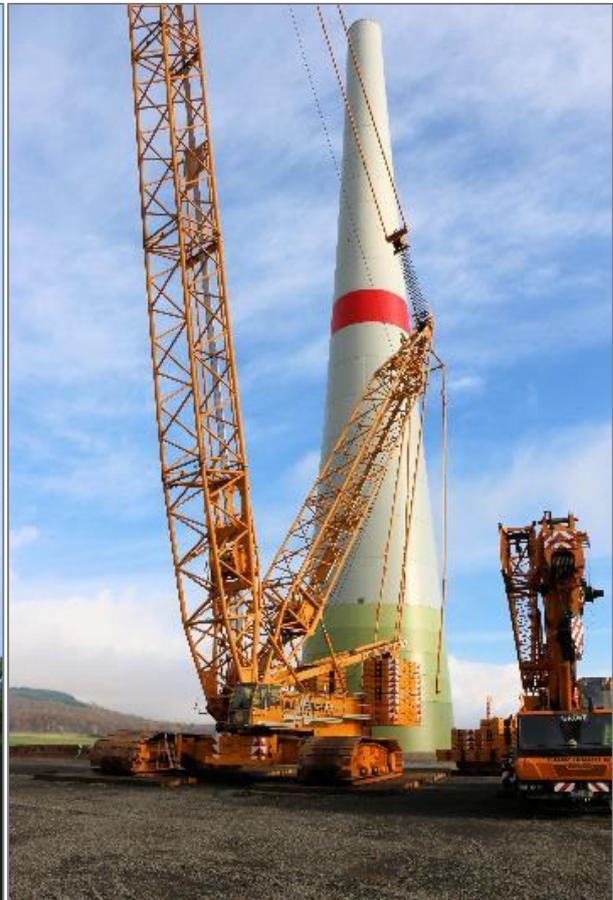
Stahlrohrturm (© Schnittstelle Boden)
